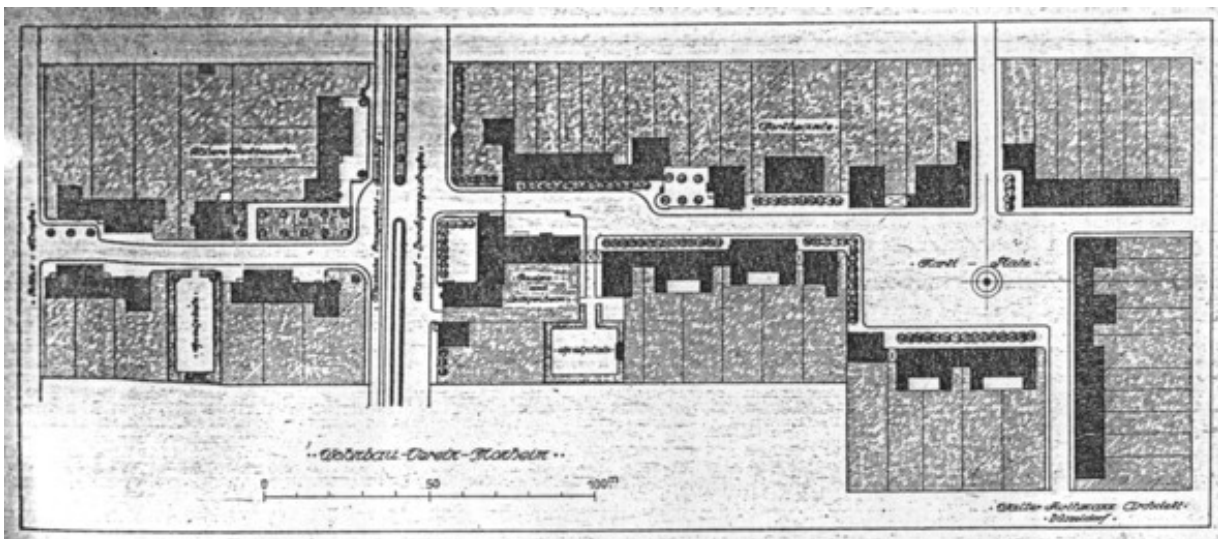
Lageplan der Siedlungsanlage in Monheim – Architekt: Walter Furthmann
